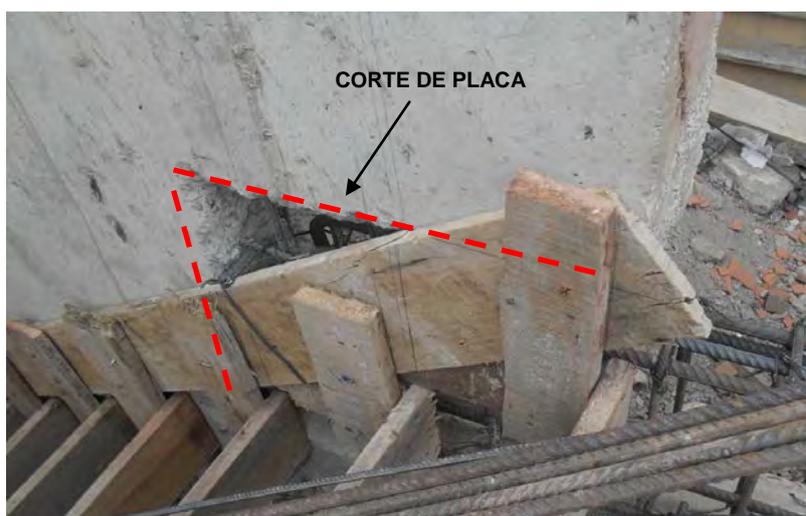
Placa cortada con el fin apoyar una viga de concreto.
